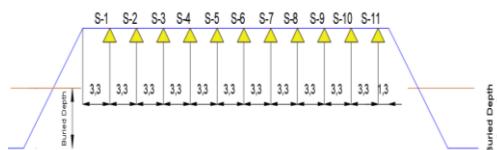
Support segmen *pipe bridge* sungai Gunungsari
